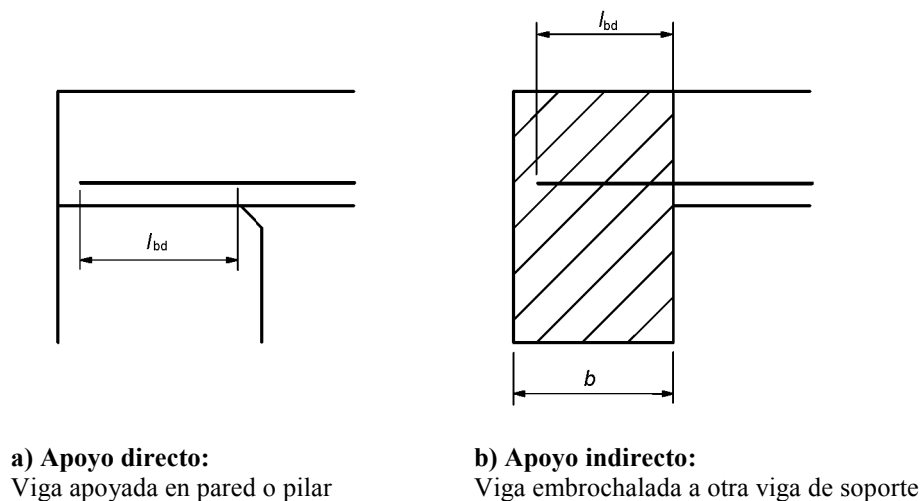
Anclaje de la armadura inferior en apoyos extremos
